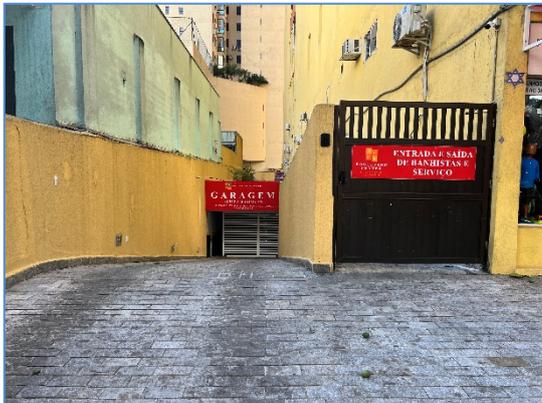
Acesso ao subsolo Junto a Rua Mario Ribeiro
